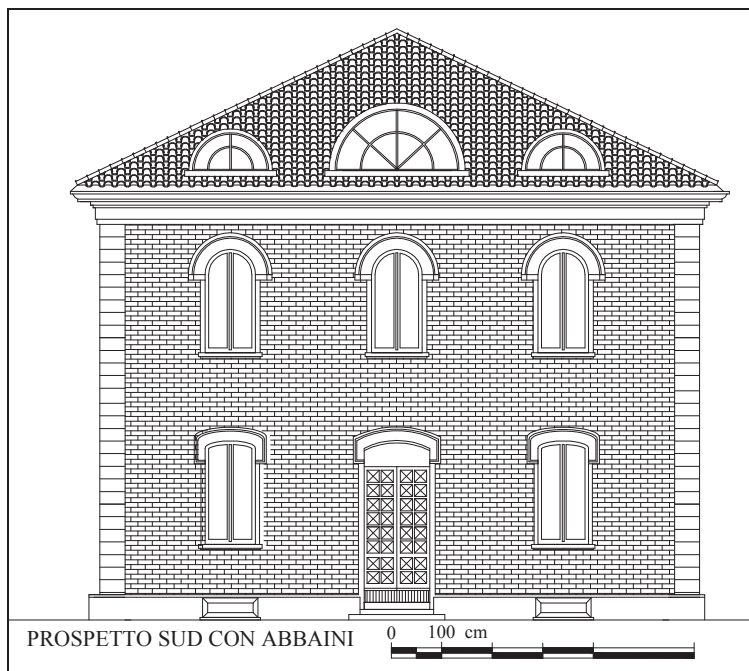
Caso di studio – Strategia a) Prospetto sud con abbaini.
